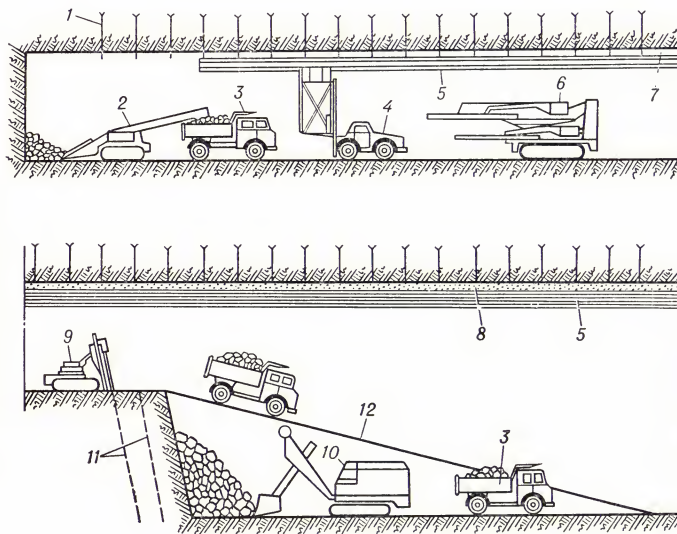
Схема сооружения камер и тоннелей уступным забоем: 1 — анкерное крепление; 2 — породопогрузочная машина; 3 — автомобиль-самосвал; 4 — автопогрузчик с рамой; 5 — вентиляционный трубопровод; 6 — самоходная буровая установка; 7 — предохранительная металлическая сетка; 8 — бетонная крепь; 9 — буровой станок; 10 — подземный экскаватор; 11 — взрывные скважины; 12 — пандус.
